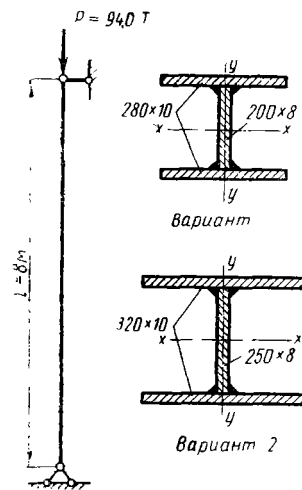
К примеру расчета стойки на центральное сжатие
